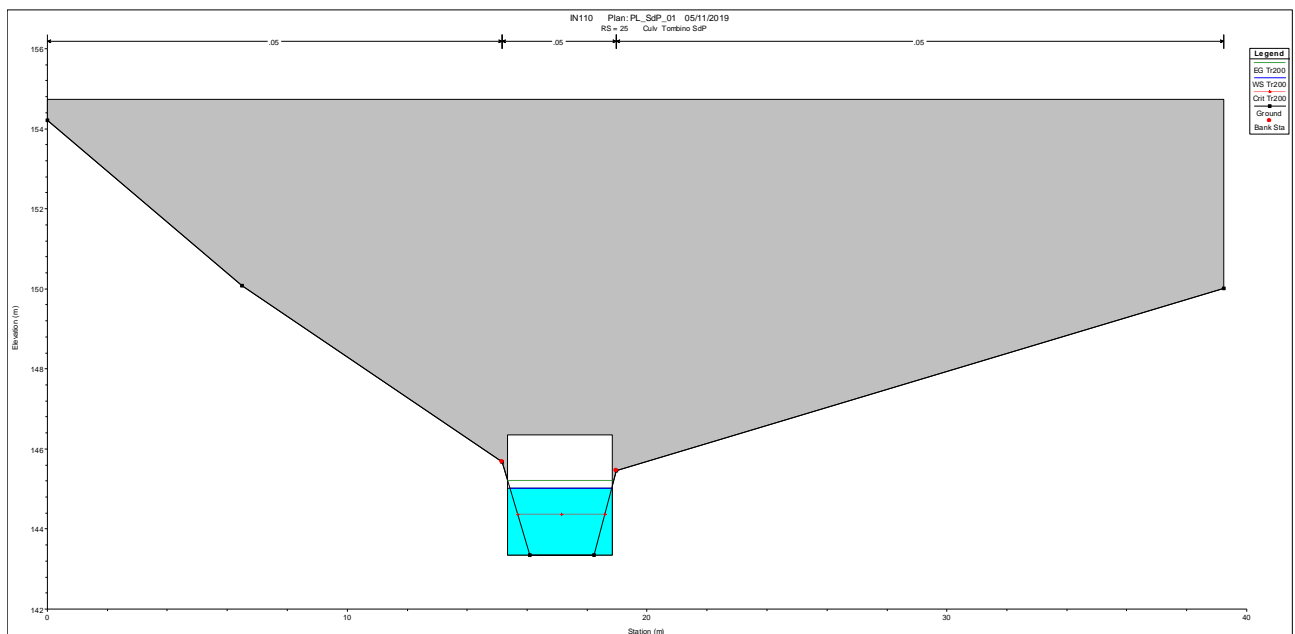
Sezione valle manufatto – stato di progetto interferenza IN110.
